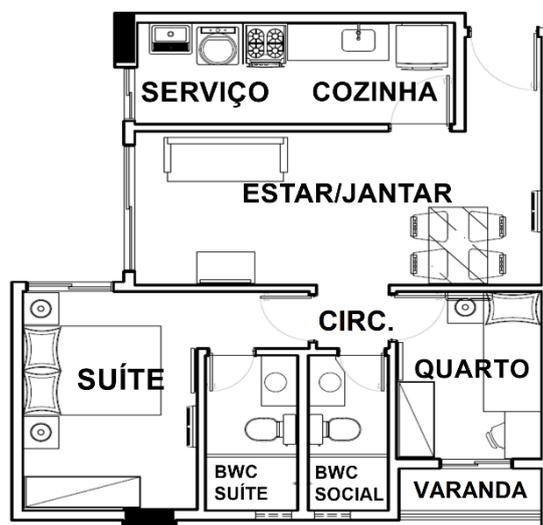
Planta do pavimento tipo Residencial Promenade.
